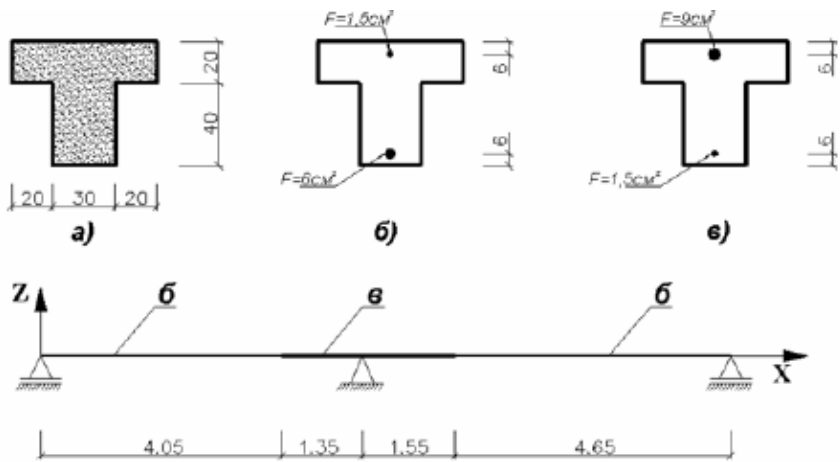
Перерізи елементів балки а) розміри перерізу, б) пролітний переріз, в) опорний переріз.
